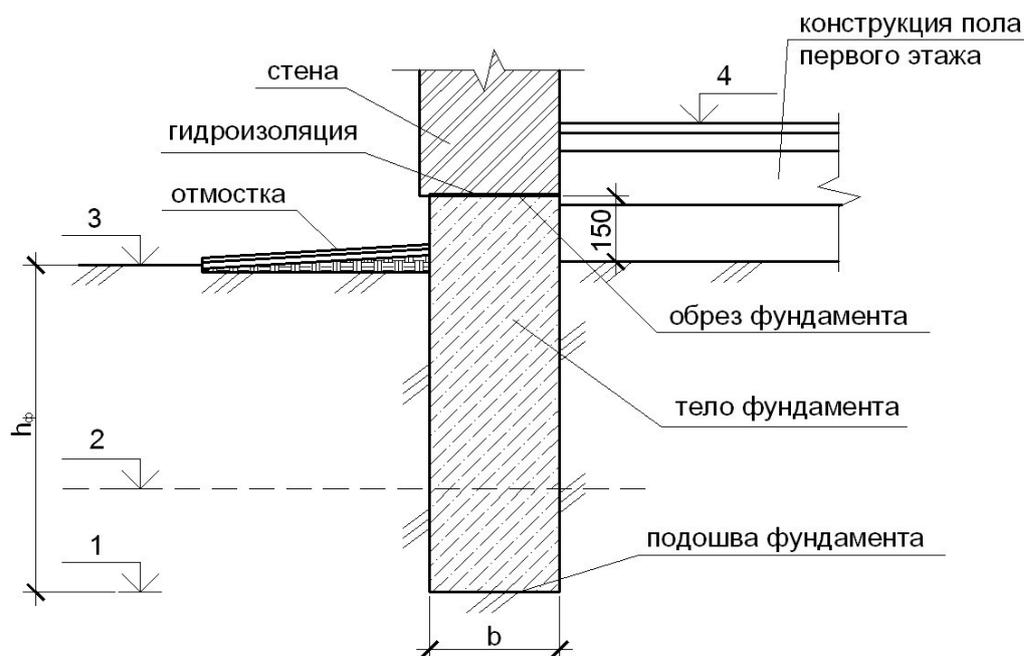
Основные элементы фундамента: 1– отметка глубины заложения фундамента; 2 – отметка уровня грунтовых вод; 3– планировочная отметка; 4– отметка уровня пола первого этажа; b – ширина подошвы фундамента; $h_{\text{ф}}$ - глубина заложения фундамента.
